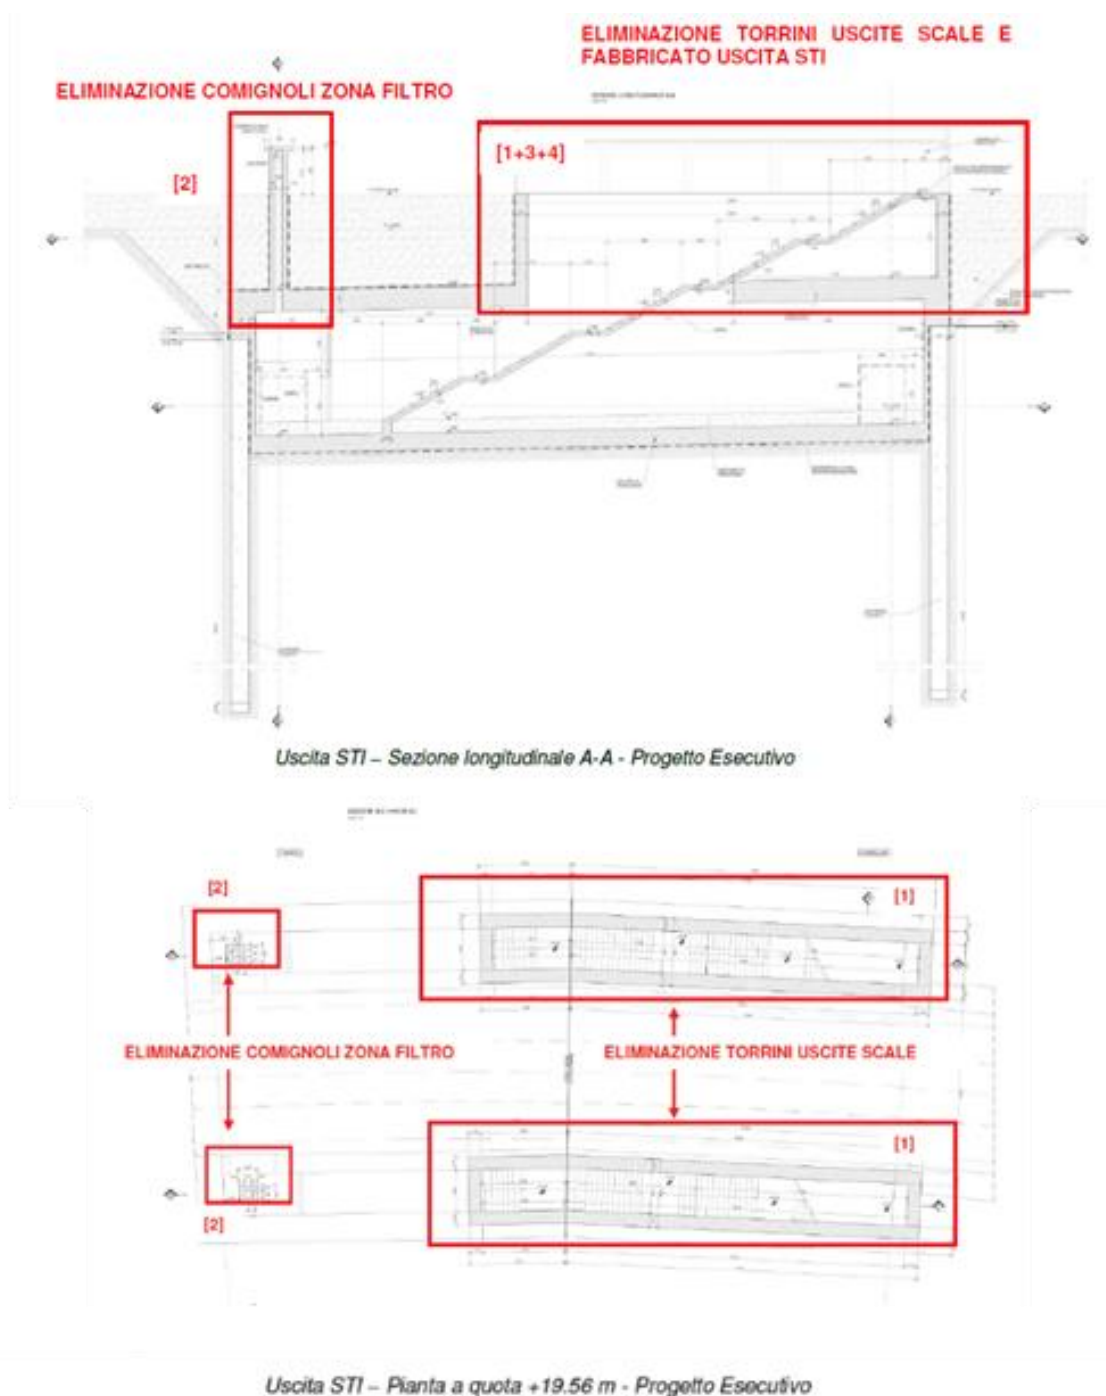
Pianta e sezioni longitudinali delle opere previste nel Progetto originario, con indicazione nelle aree in rosso delle opere non previste nel progetto in variante
